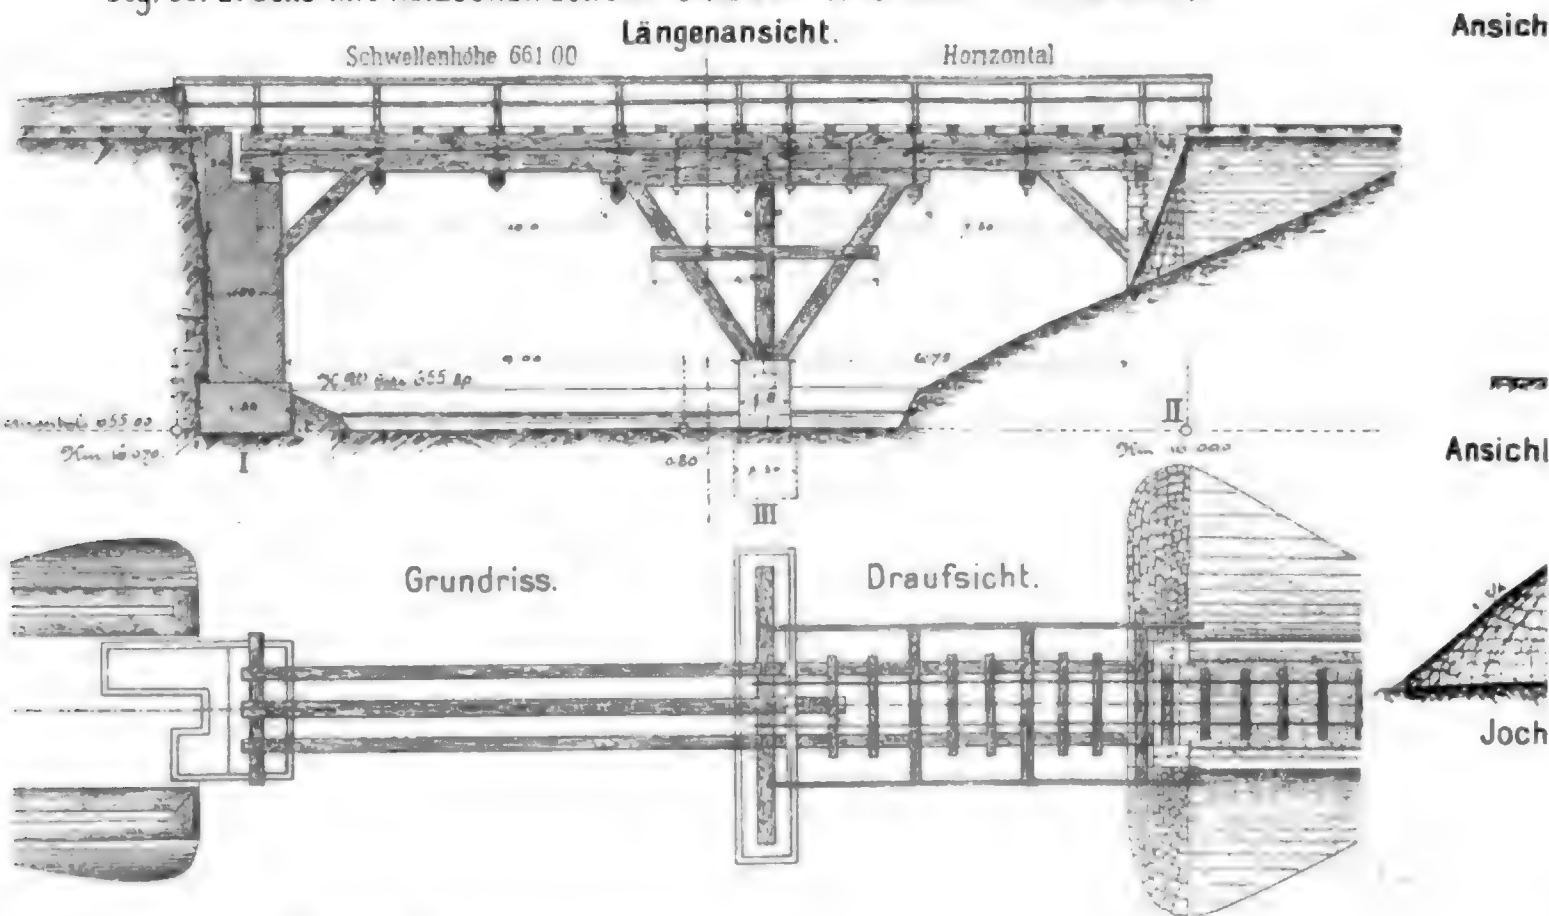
Brücke mit Holzconstruction 1 Öffn. á 10<sup>m</sup> u. 1 Öffn. á 7<sup>5</sup>m in Km. 1608.
